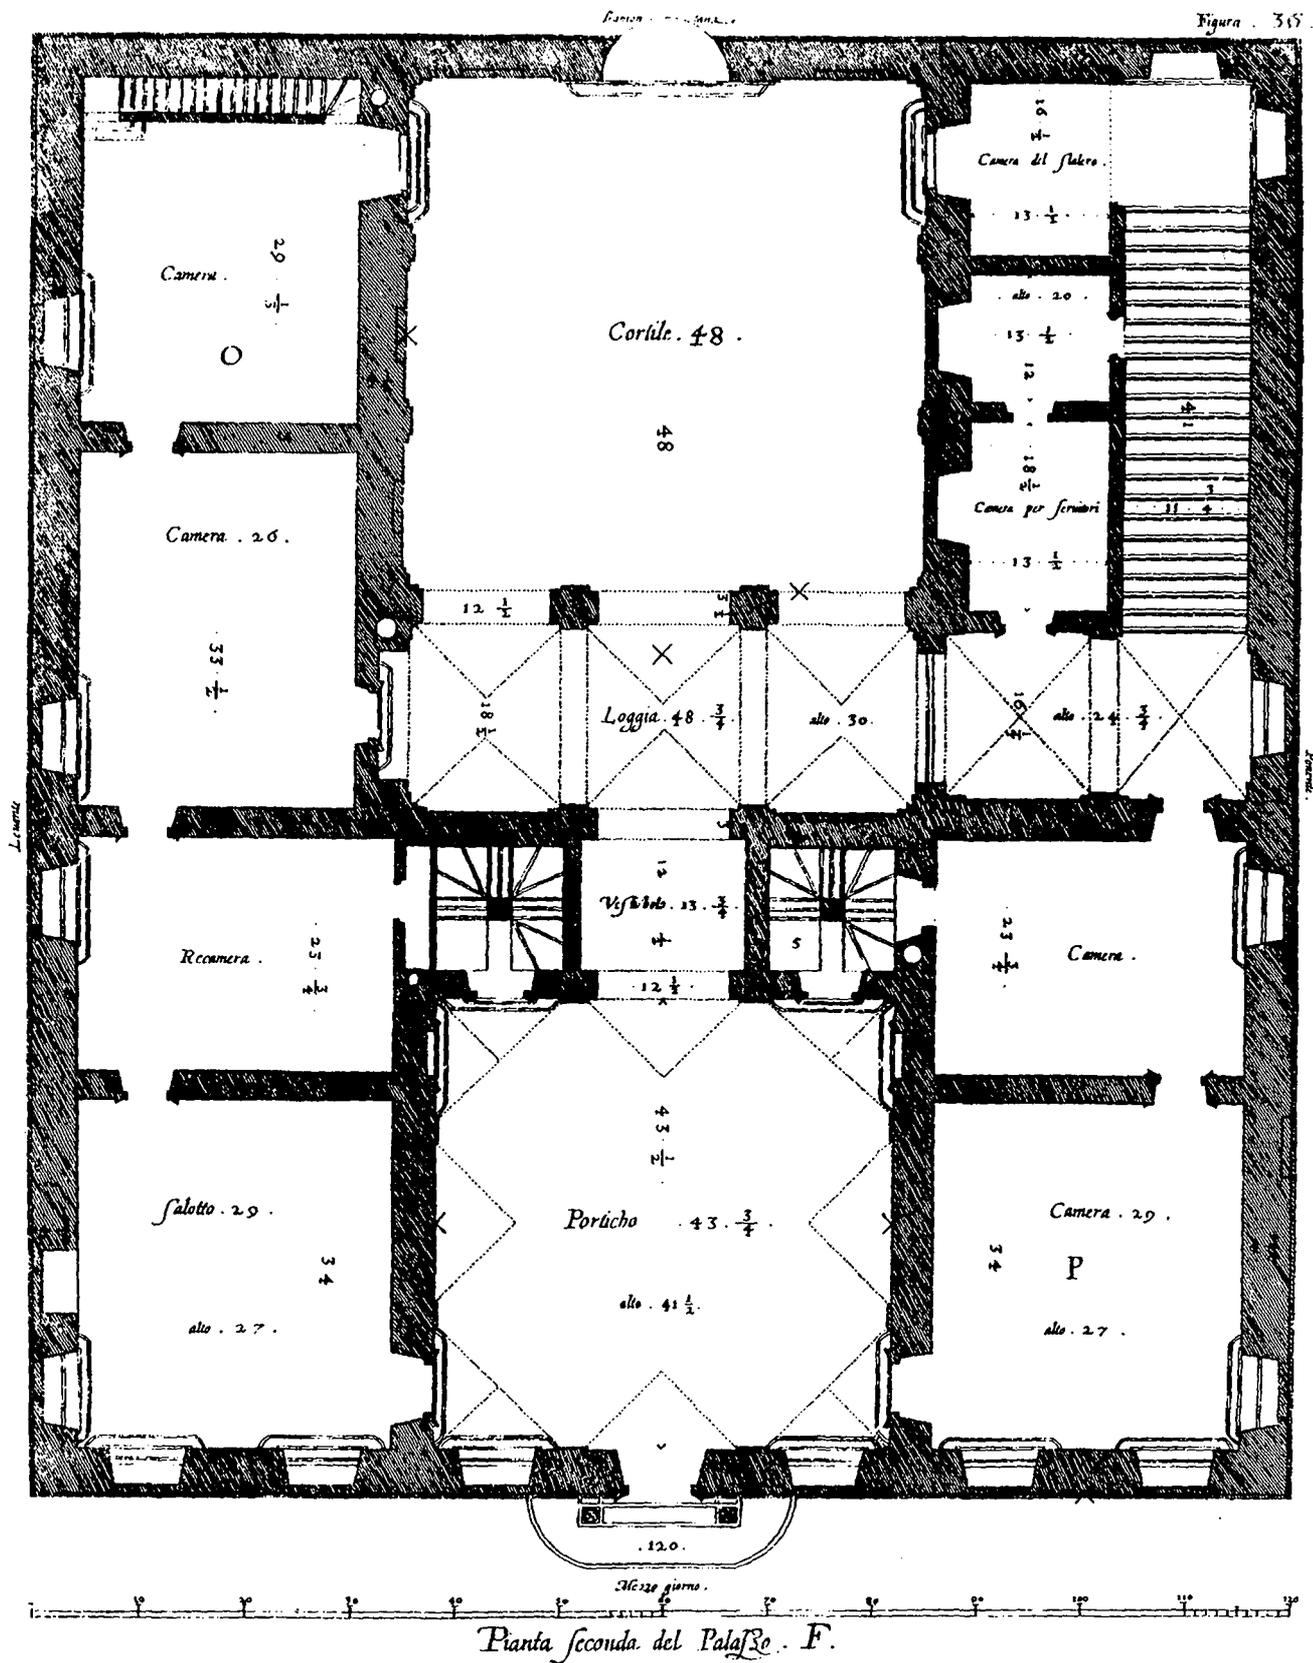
Palais Spinola, Strada Nuova n° 5; plan du rez-de-chaussée; l'Est et l'Ouest sont inversés, le grand escalier devrait figurer sur la gauche du plan.
